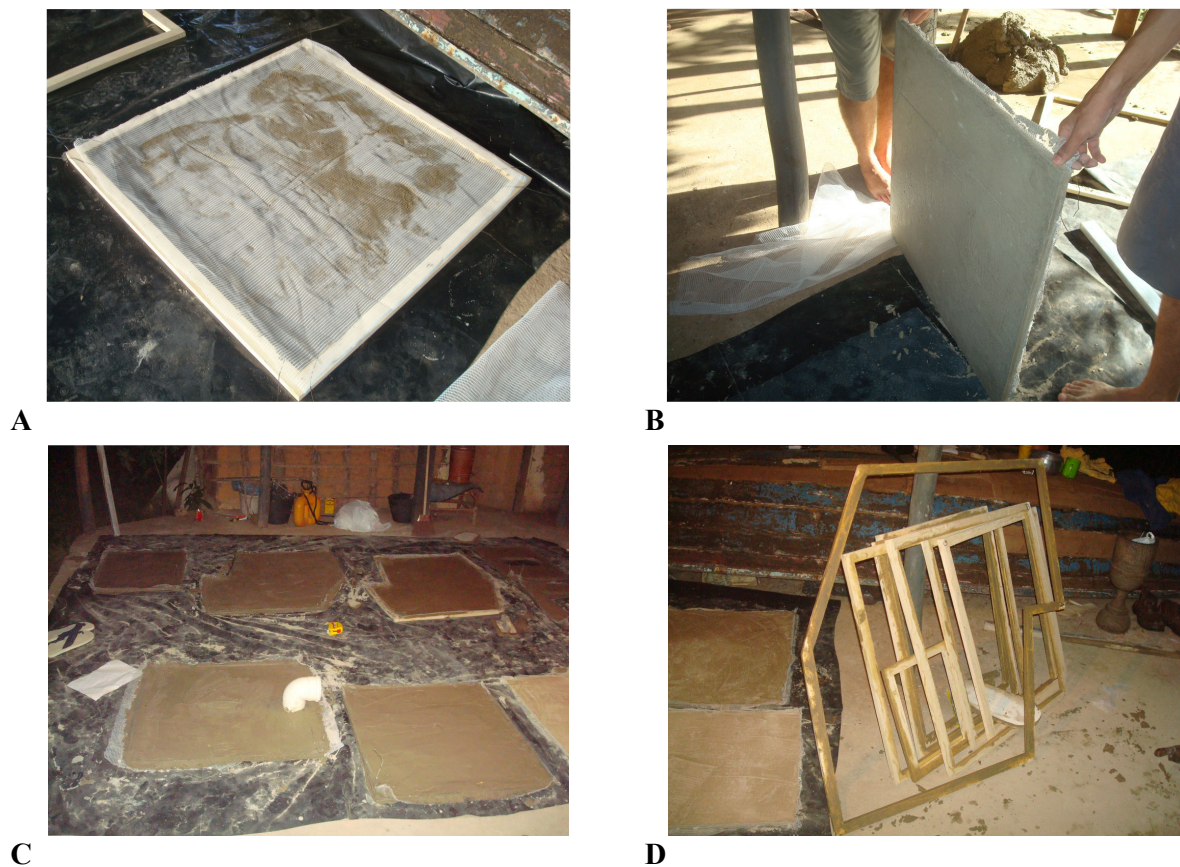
A- Colocação de tela no molde com argamassa; B- Placa pronta; C- Placas argamassadas e desmoldadas; D- Moldes após utilização.
